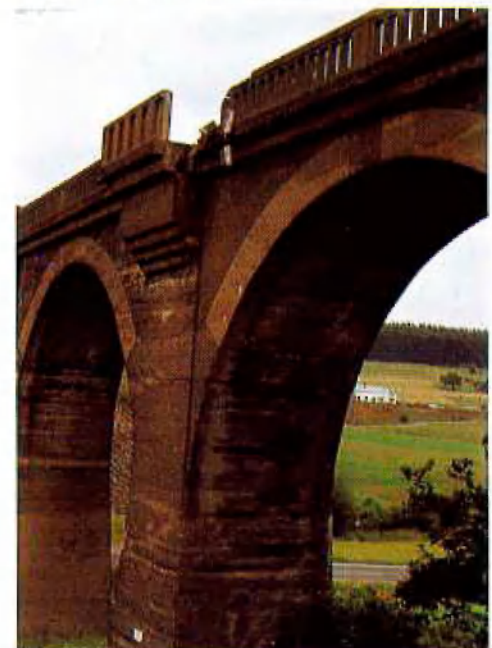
Korrosion der Bewehrung wegen fehlender Betondeckung an den Brüstungen
